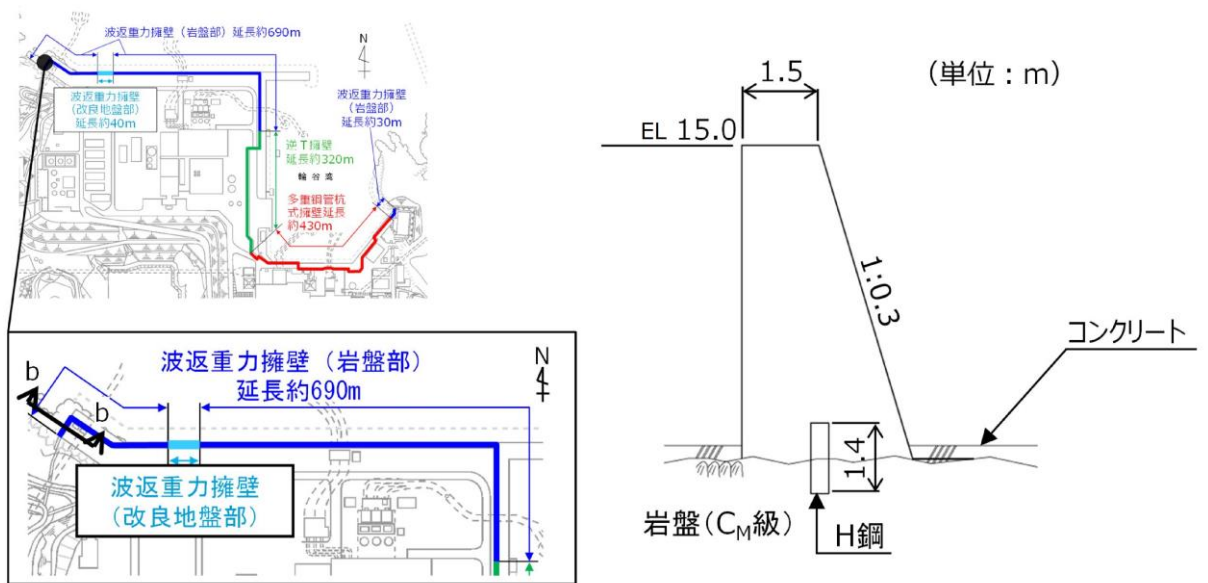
防波壁（波返重力擁壁）西端部（b - b 断面） 断面図
